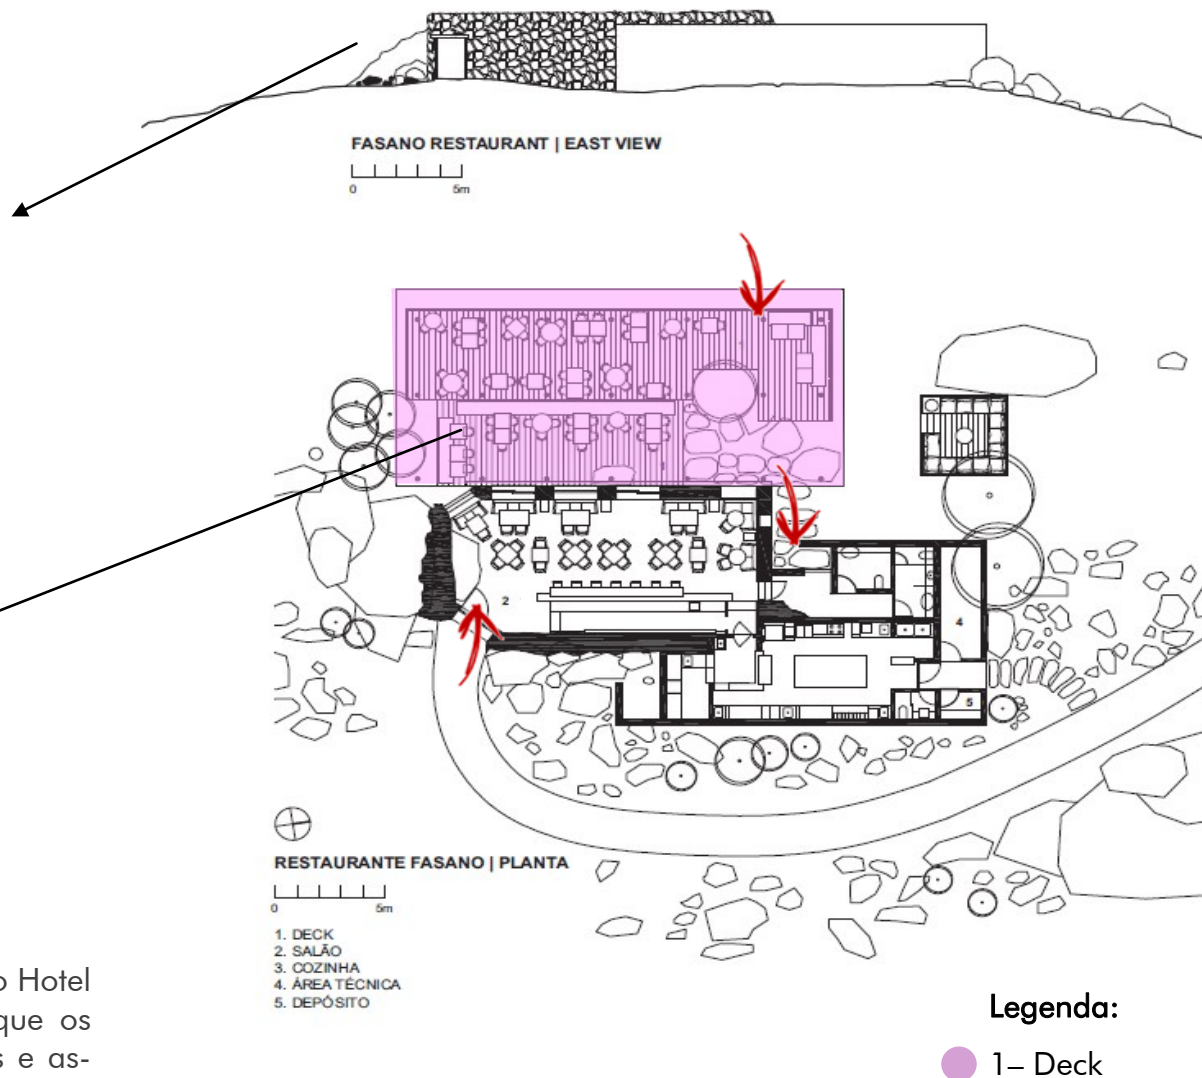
Hotel Fasano Las Piedras—Fonte: <https://www.archdaily.com.br/01-30866/fasano-las-piedras-hotel-> - Modificado por Camilla Parra
